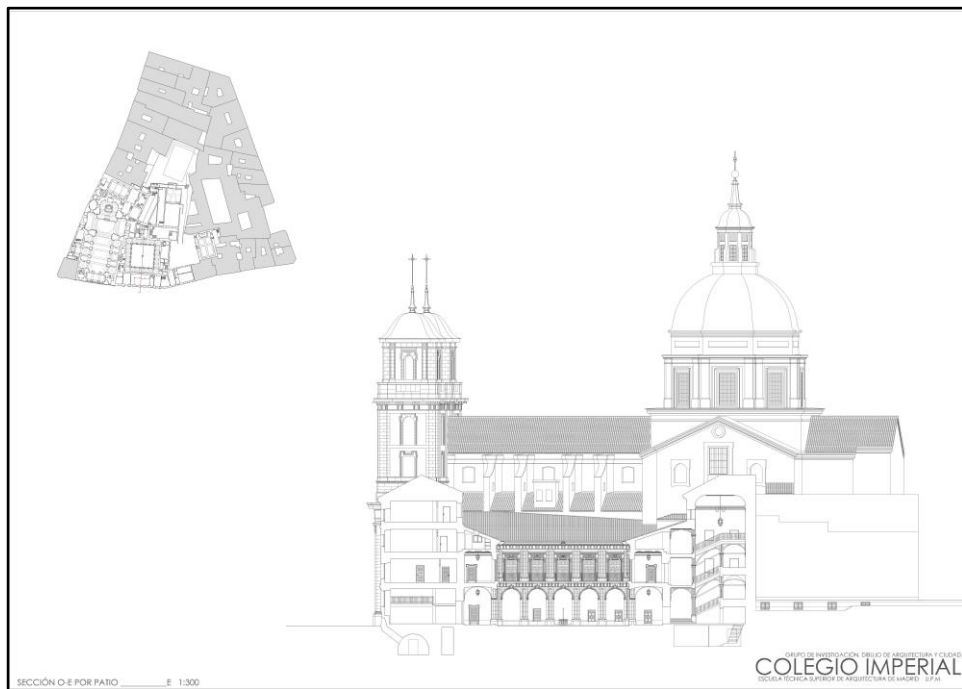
Concatedral e Instituto de San Isidro: sección y alzado longitudinal por el eje del claustro.
